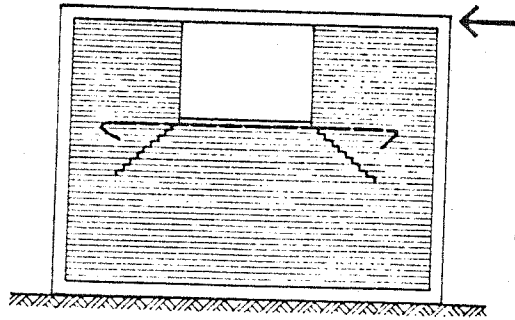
Armadura de antepecho para evitar fisuración en abertura no enmarcable
